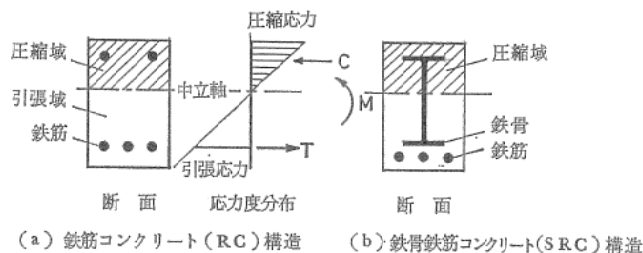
鉄筋コンクリート構造および鉄骨鉄筋コンクリート構造
